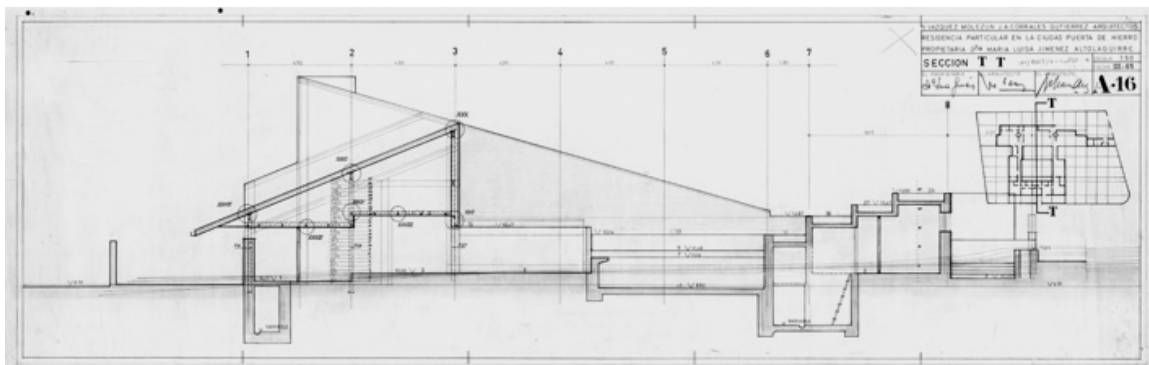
Casa Huarte. Sección T-T por el patio privado y piscina. Plano A-16. Proyecto de Ejecución. Marzo 1965. Plano: Legado: Vázquez Molezún, Fundación COAM
